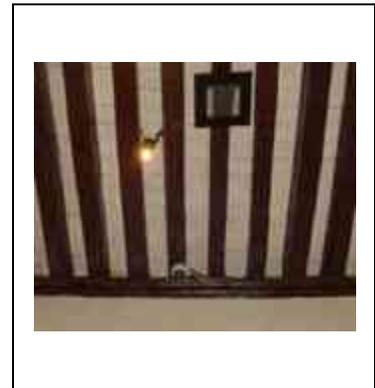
Viguería con tapa de ladrillo de barro en cubierta de planta alta, casa de Isidro Huarte.
